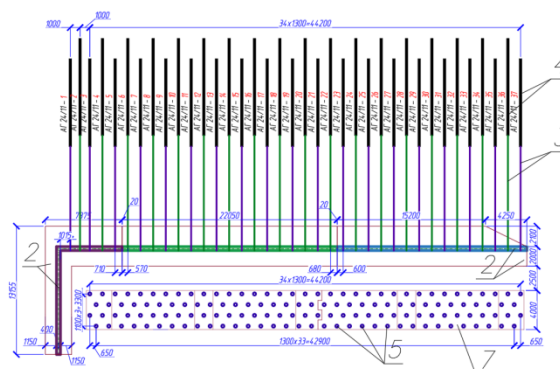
Схема устройства монолитных железобетонных ростверков и диафрагм на завершающем этапе: 1 – призматические железобетонные сваи; 2 – существующий монолитный угловой железобетонный ростверк; 3, 4 – грунтовые анкера ЭРТ; 5 – буронабъекционные сваи ЭРТ усиления основания; 6 – монолитные железобетонные контрфорсы; 7 – монолитный железобетонный ростверк.
